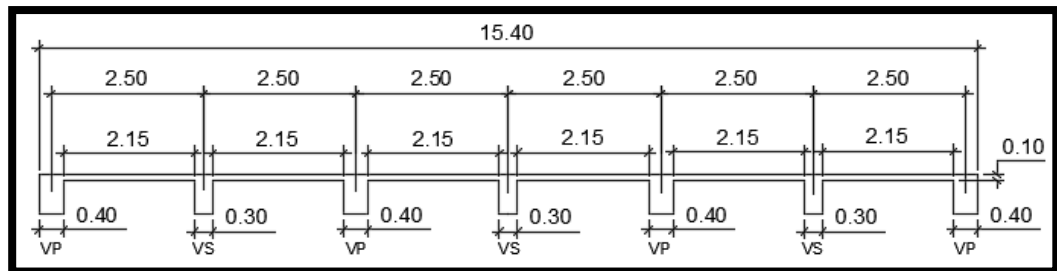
Corte 1-1 en sección transversal de losas y vigas.
